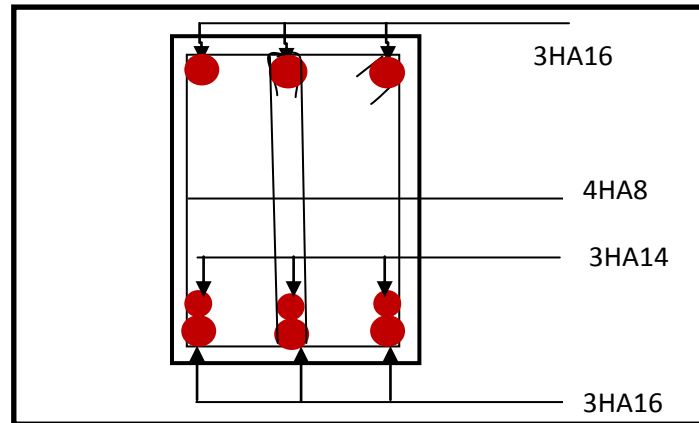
Ferrailage en travée d'une poutre principale.
